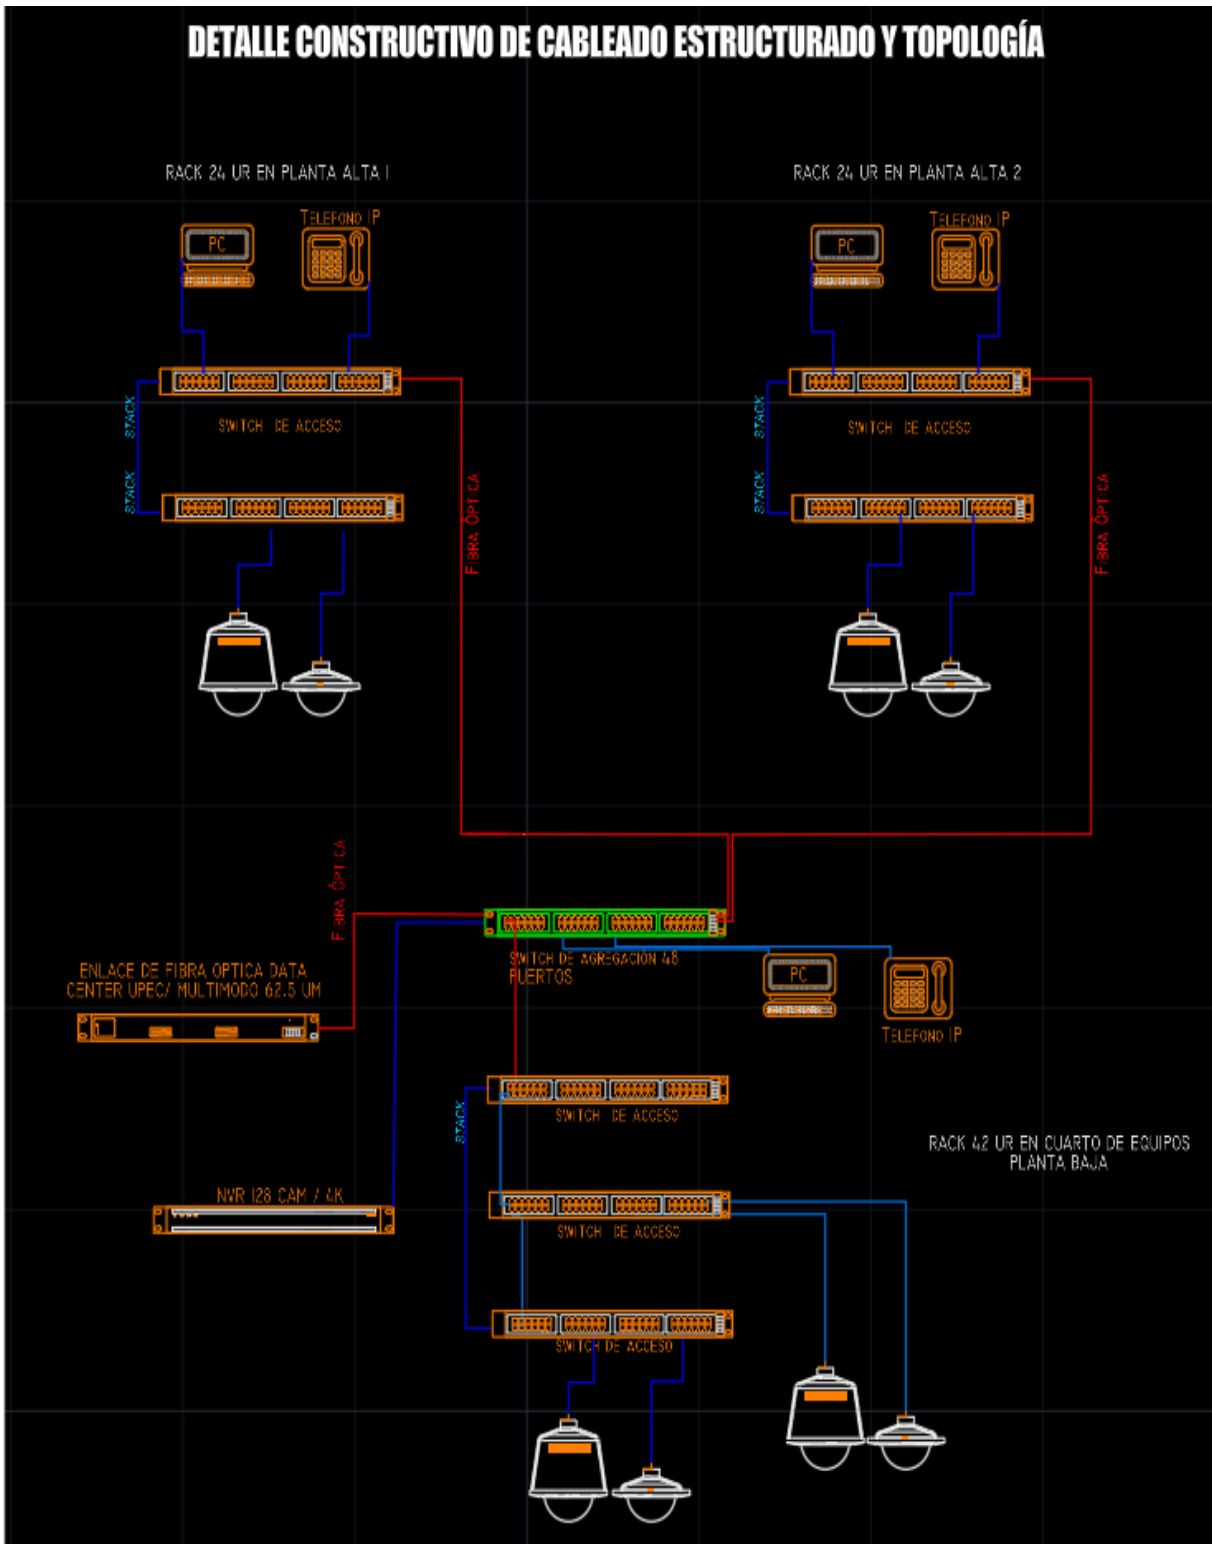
Detalle Constructivo de Cableado Estructurado y Topología
